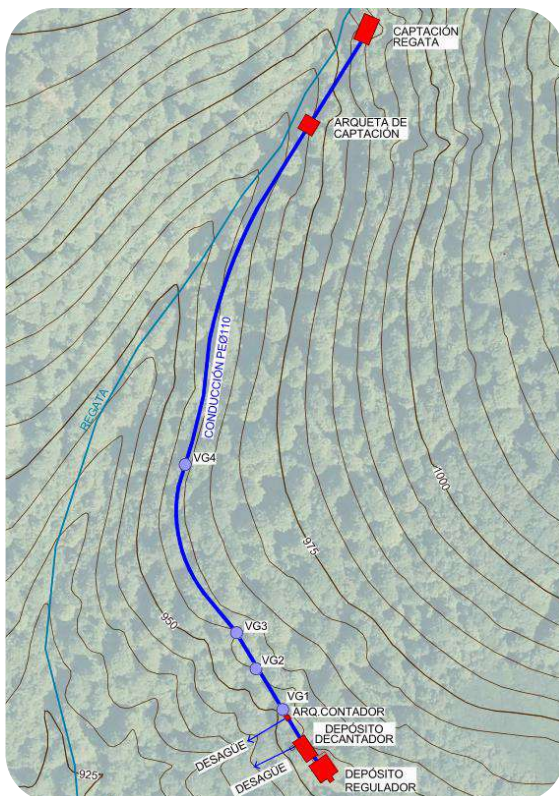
Planta general de las actuaciones de renovación de la conducción.
